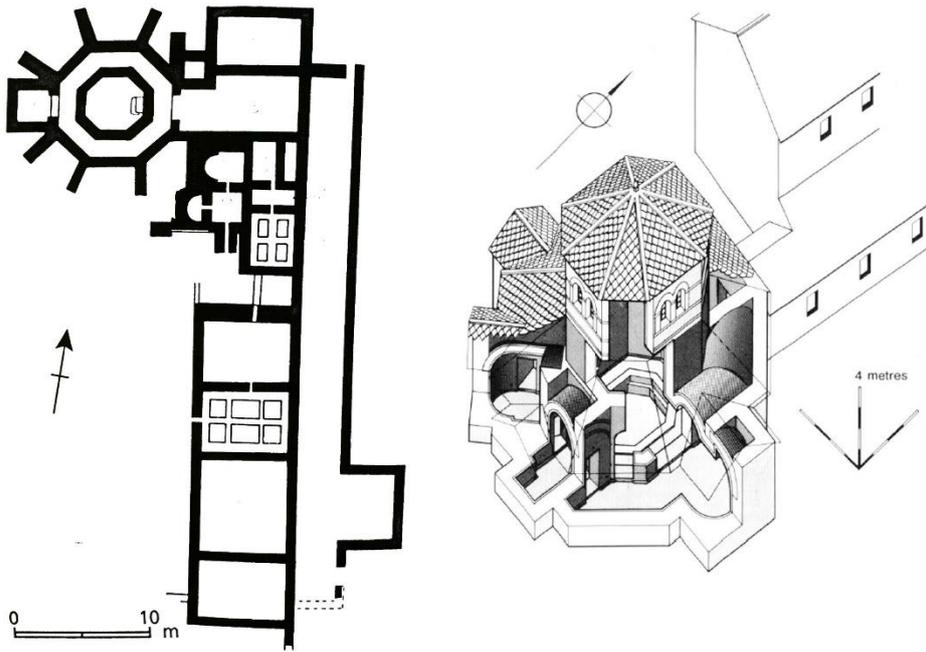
Planta baixa de Lufton. Em detalhe, gravura da provável configuração das thermae. Elaborado com base em Walters (1996) e Neal & Cosh (2009).
